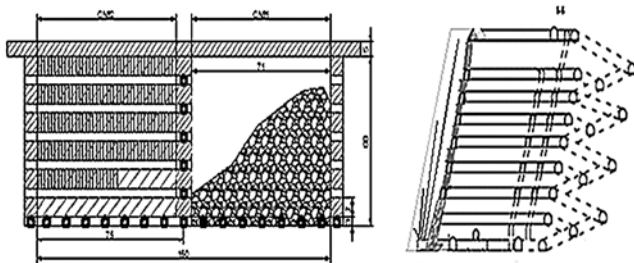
Вариант этажно-камерной системы разработки с увеличенной высотой подэтажа
